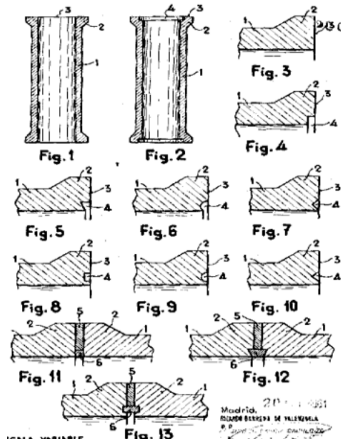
Acoplamiento de tramos prefabricados en conducciones.
